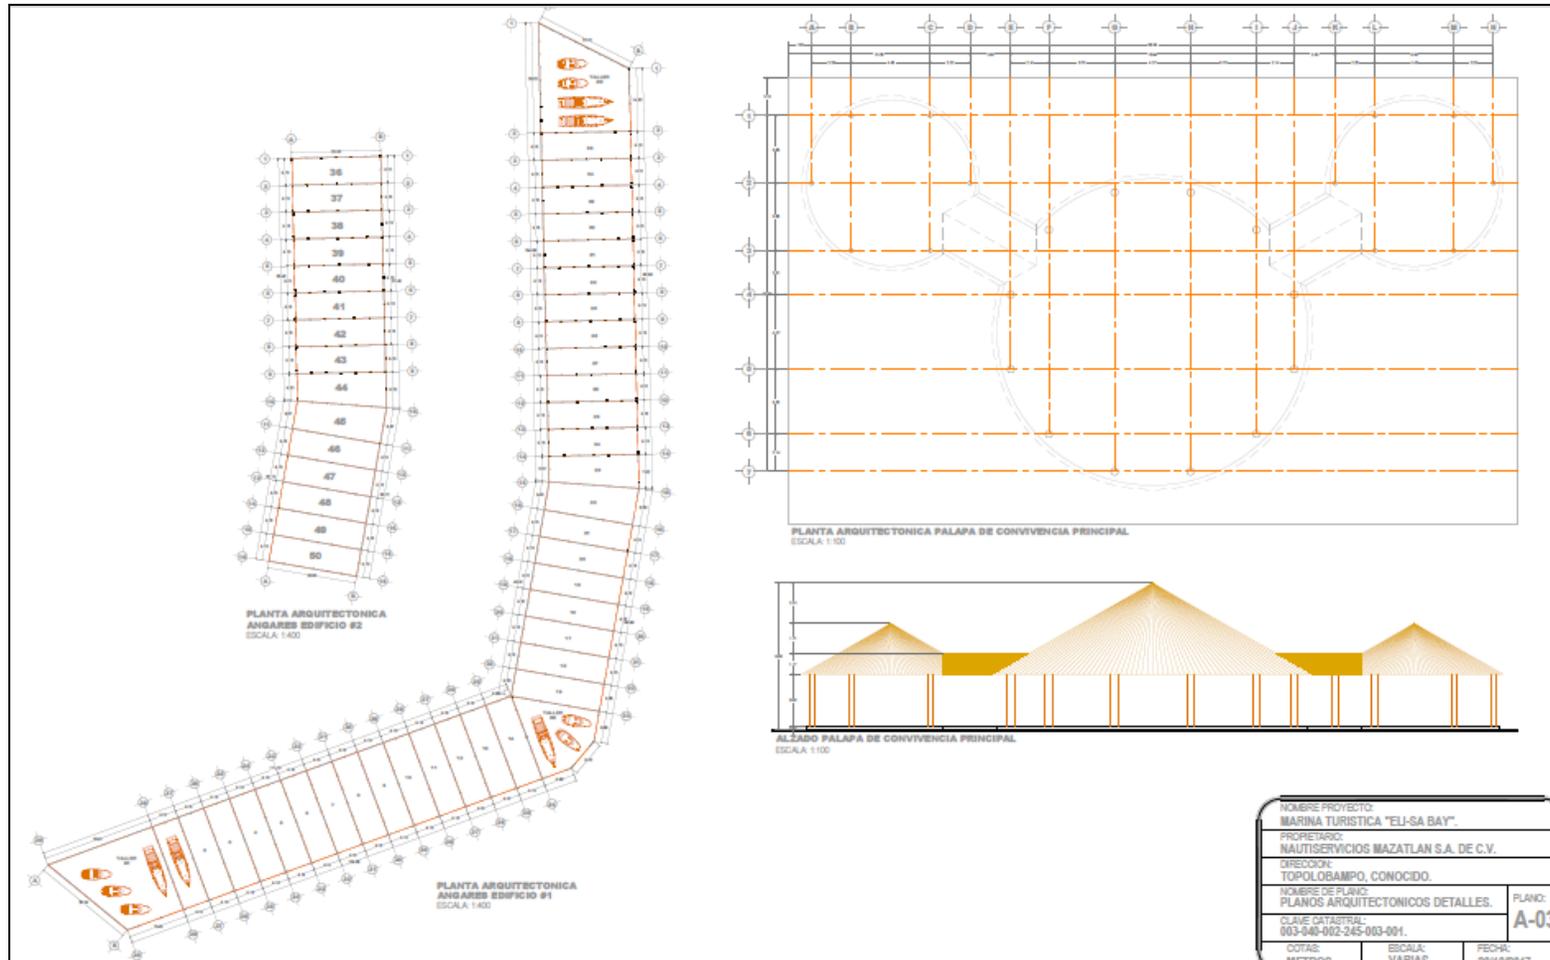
Detalles arquitectónicos de hangares y palapa de convivencia. Ver detalles en Plano Arquitectónico A-03.
